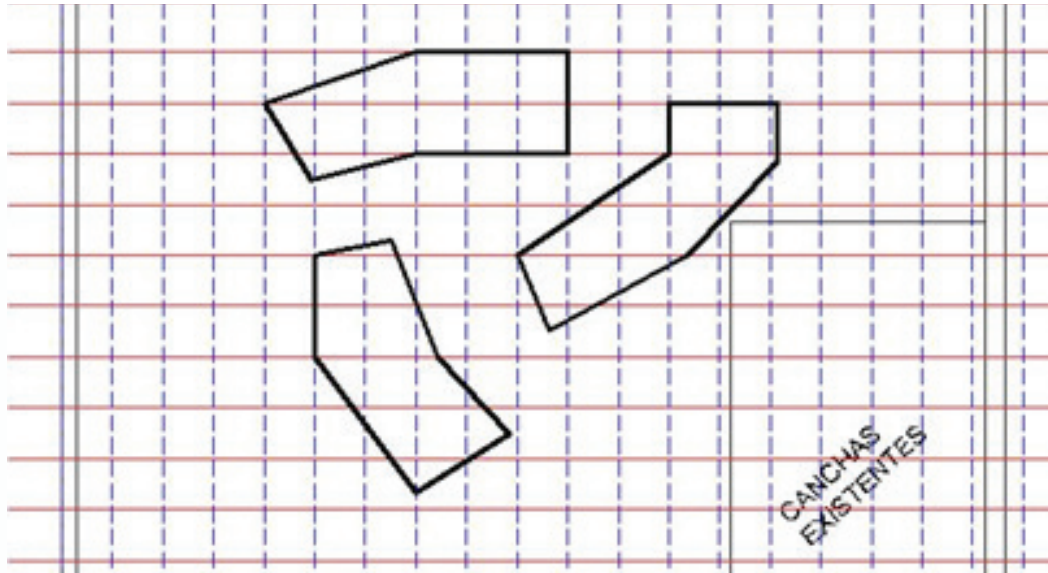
Diseño escogido para la planta de la propuesta arquitectónica.
